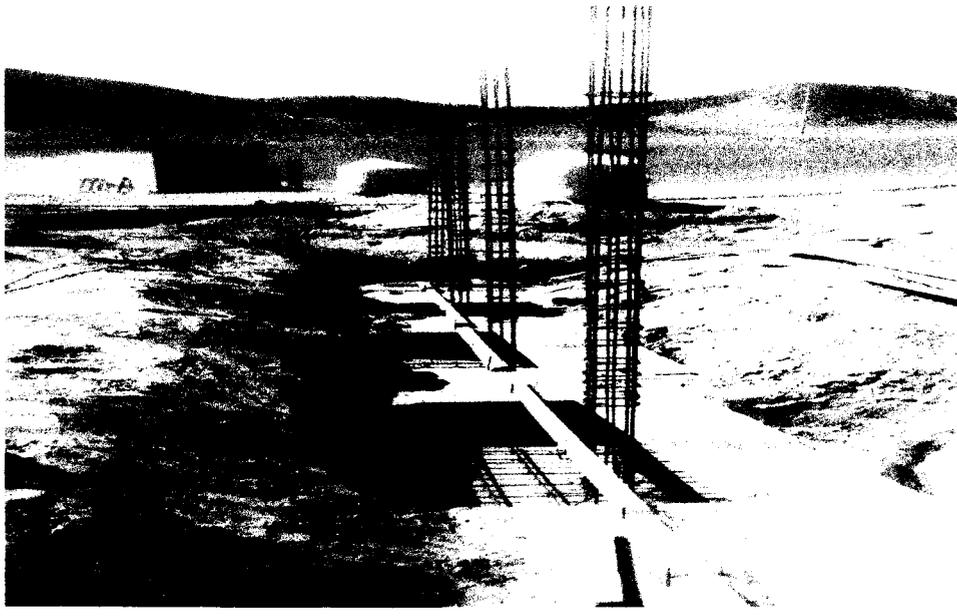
Vista del lado Oeste del plantado de acero de columnas
